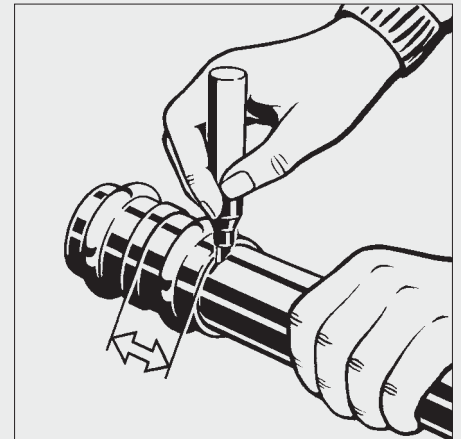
/3: Перед опрессовкой сделать маркировку глубины вставки и проконтролировать её перед включением инструмента
